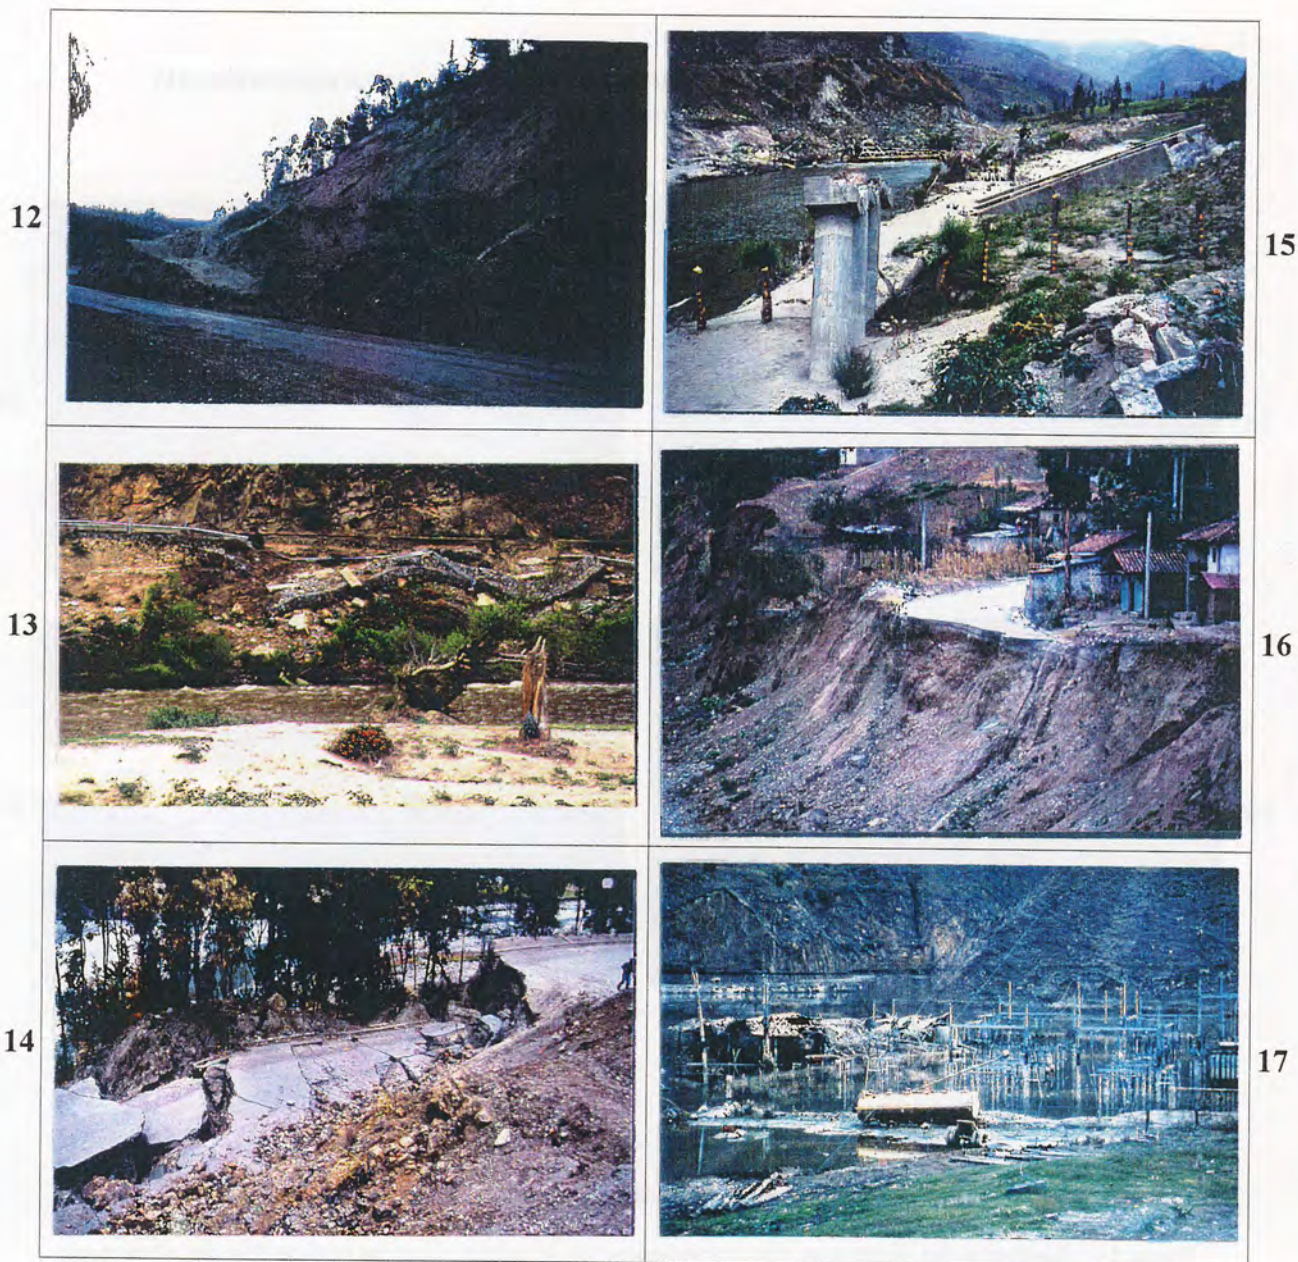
route (Panaméricaine) dégagée des matériaux d'un des glissements induits qui l'obstruait.
